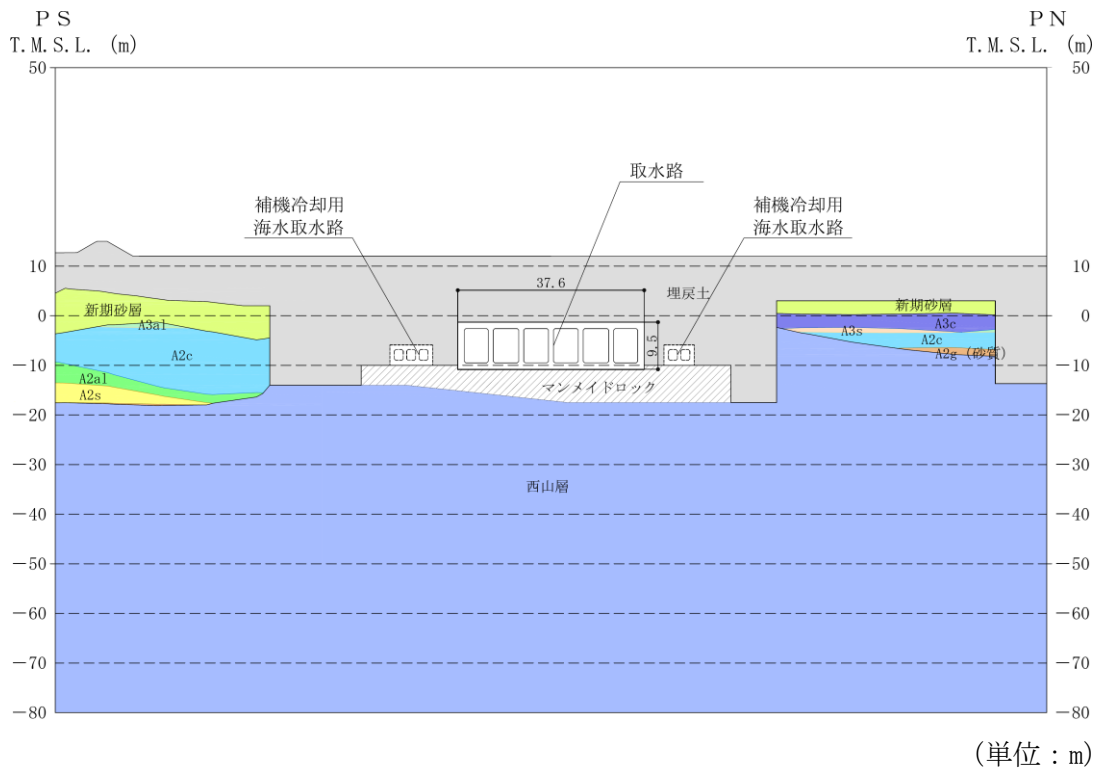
(3) 取水路の評価対象断面図 (C-C 断面)
